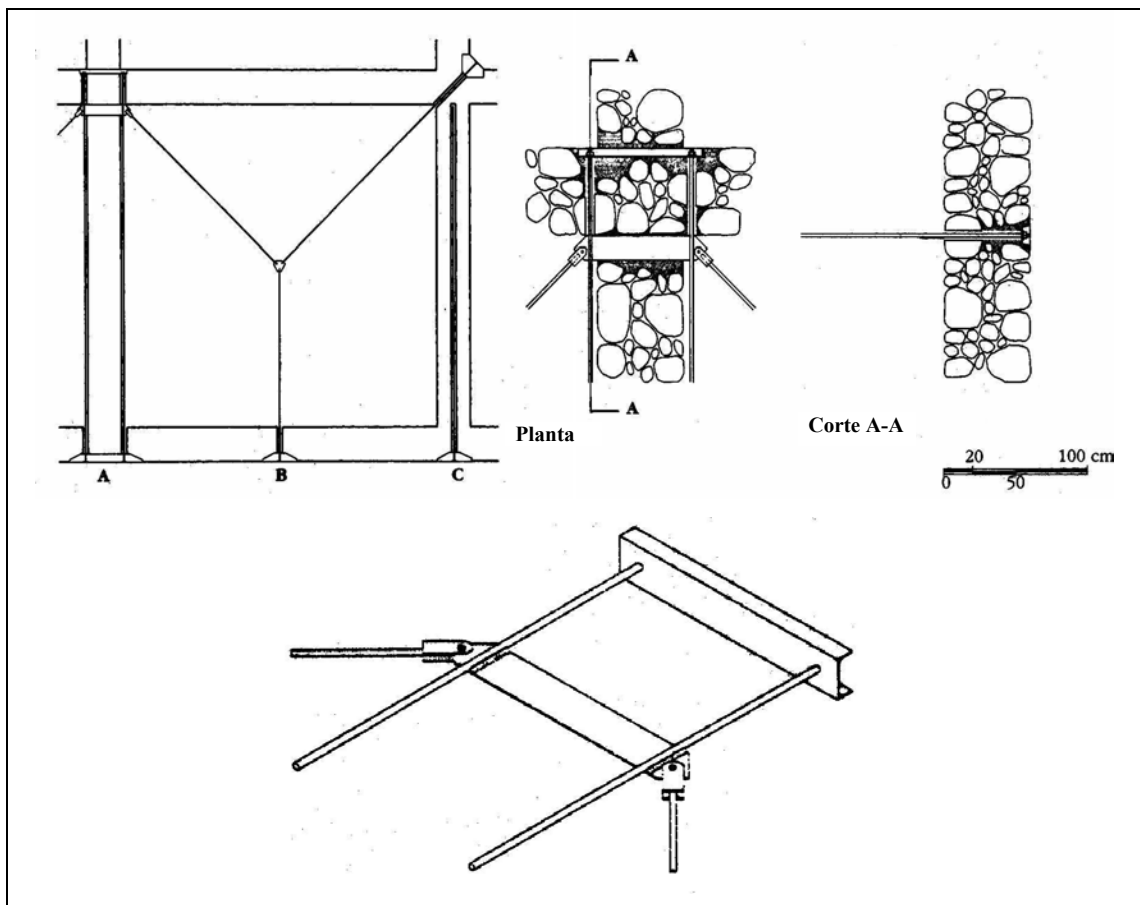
Alguns sistemas de tirantes de ligação entre paredes [Giuffrè, 1993]: A - Tirantes duplos, paralelos à parede transversal, com ancoragem externa em betão armado e ancoragem interna sobre perfil metálico tipo U (em pormenor); B - Tirante intermédio, bifurcado, com ancoragens interiores nos cantos; C - Pregagem longa com barra de aço injectada.
